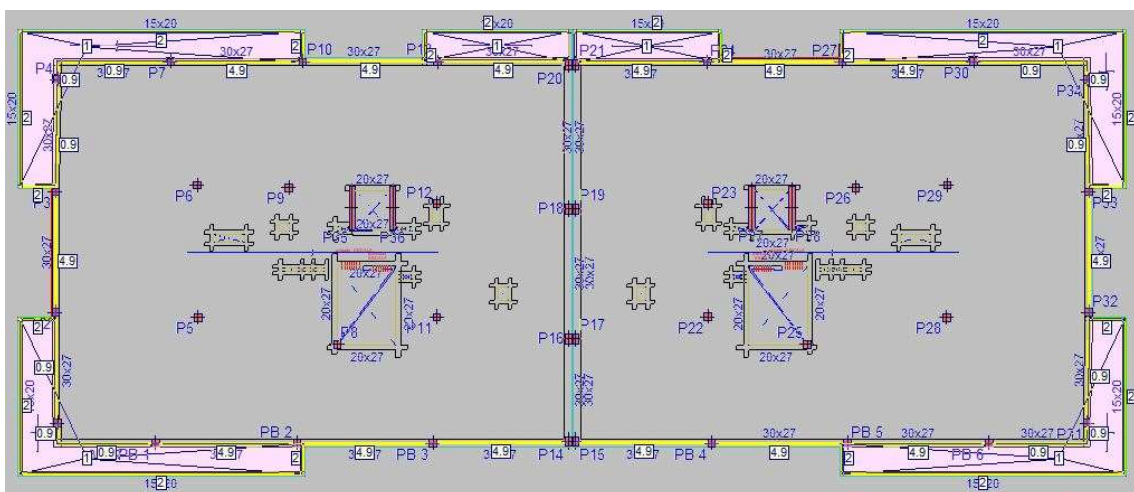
Detalle de cargas aplicadas en planta tipo
